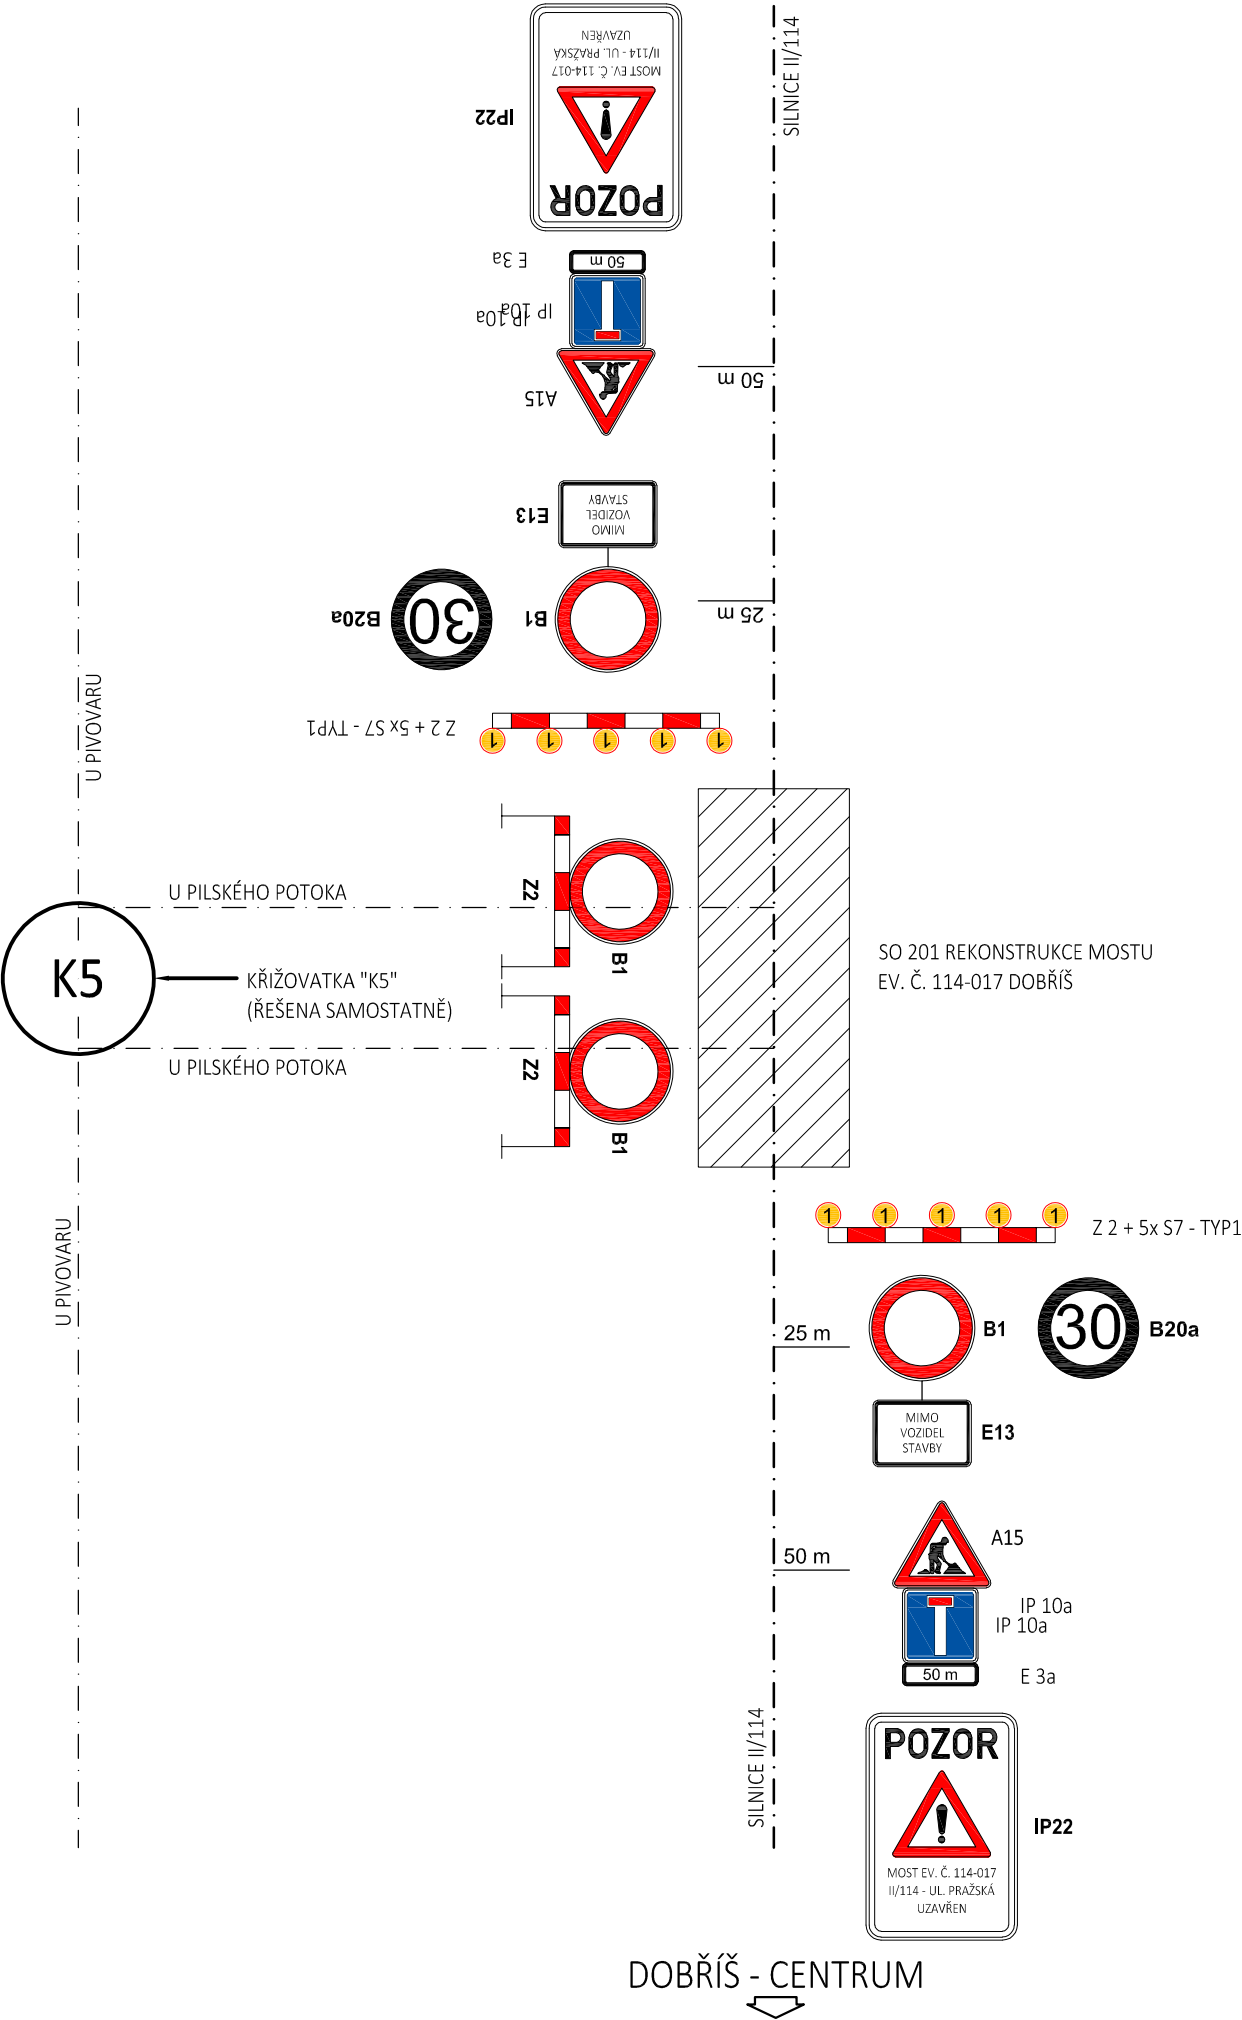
DETAILY KŘÍŽOVATEK, STAVENIŠTĚ
